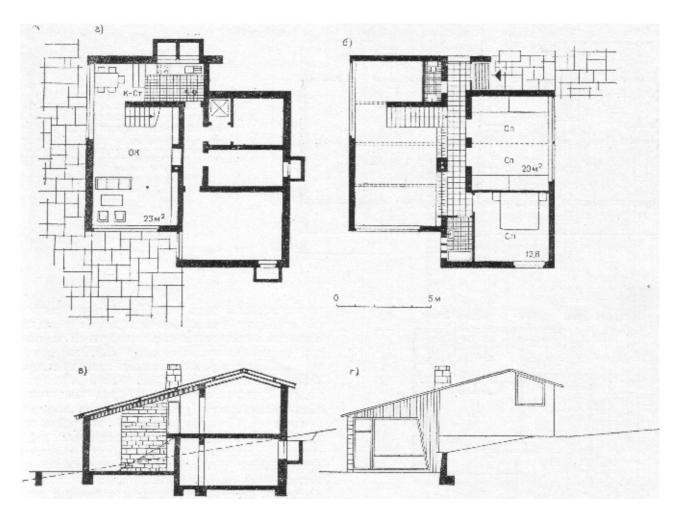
Одноквартирный четырехкомнатный дом, расположенный на рельефе (ФРГ) a — план нижнего этажа; б — план верхнего этажа; ε — разрез; ε — фасад
